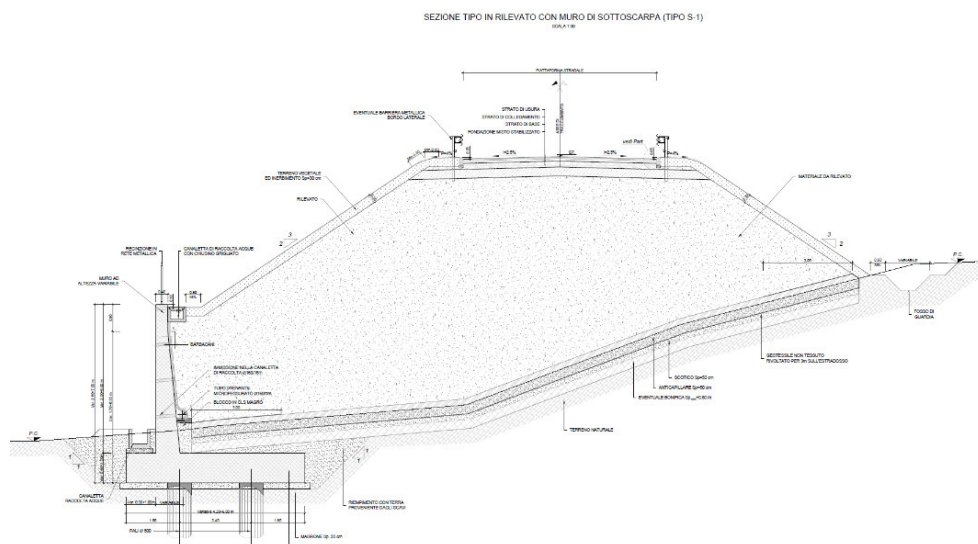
Sezione tipo stradale in rilevato con muro di sottscarpa
